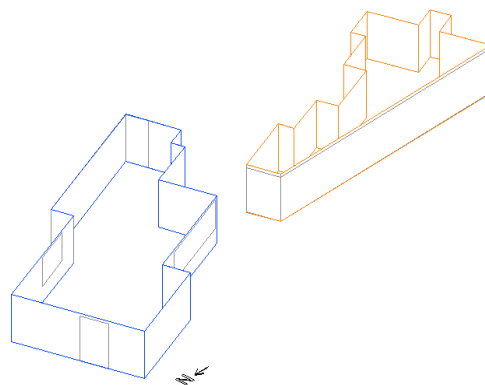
Vista em perspectiva das zonas térmicas do 15º pavimento
